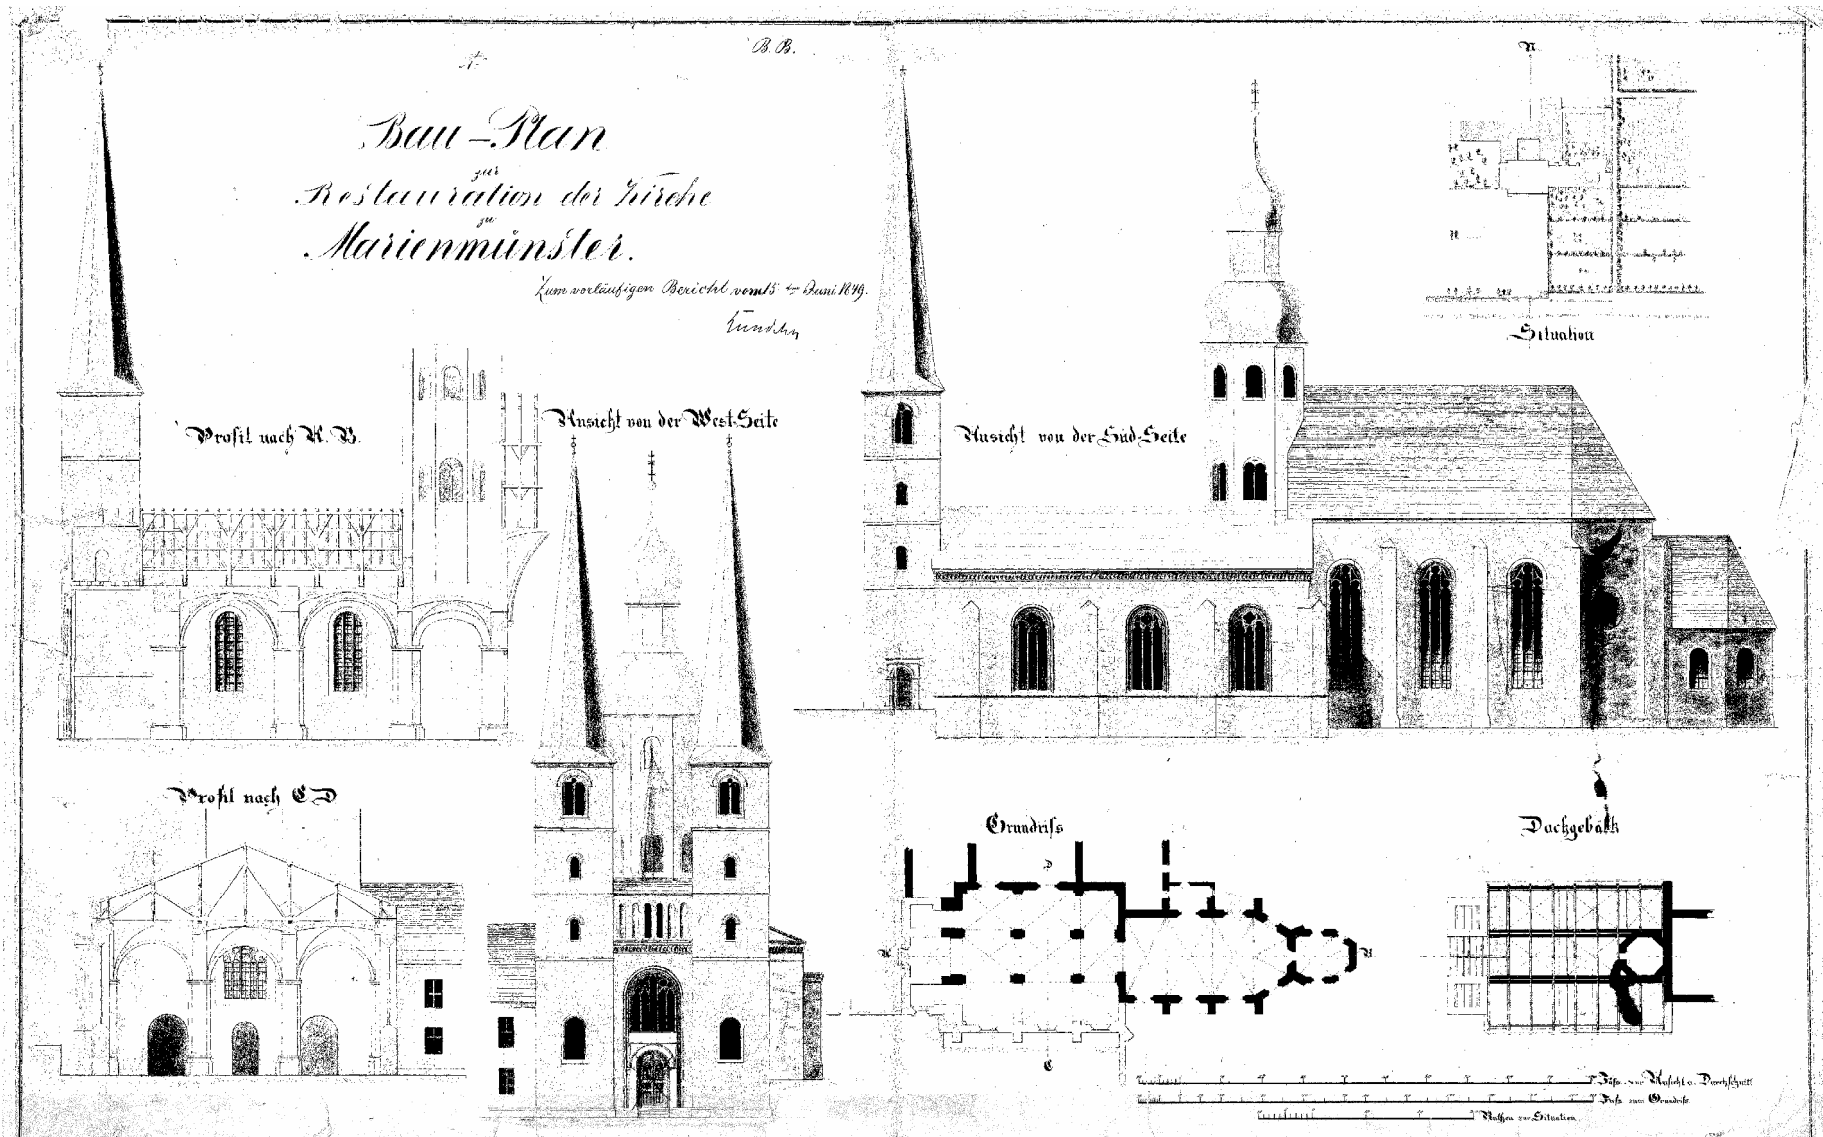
Blatt BB: Bau-Plan zur Restauration der Kirche Marienmünster. Zum vorläufigen Bericht vom 15ten Juni 1849. Lundehn. Ansichten und Schnitte M 1.500; Grundriss M 1:1000. – StBPb, Planzeichnungen Marienmünster.
